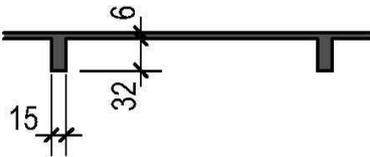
Querschnitt Rippendecke Detail [B. Walter Ing. GmbH]
